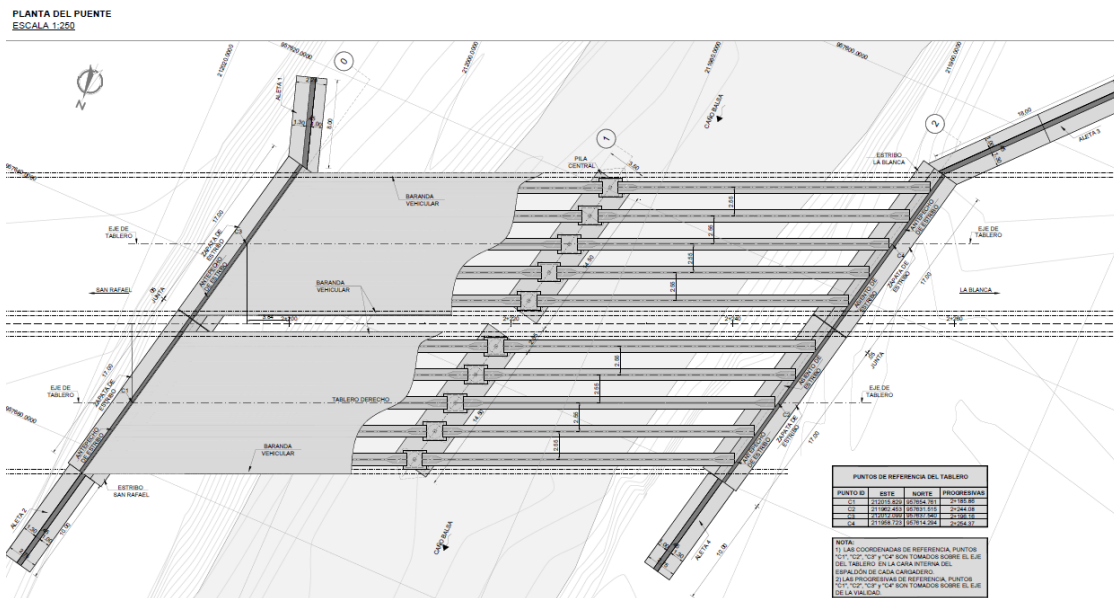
Planta de la estructura, puente Balsa. Propiedad de DCI.C.A. (2016).
